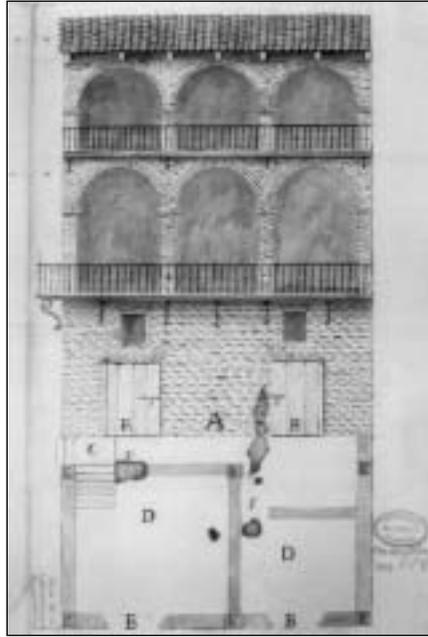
ARCHV. Sección: Planos y Dibujos. Nº 87.
